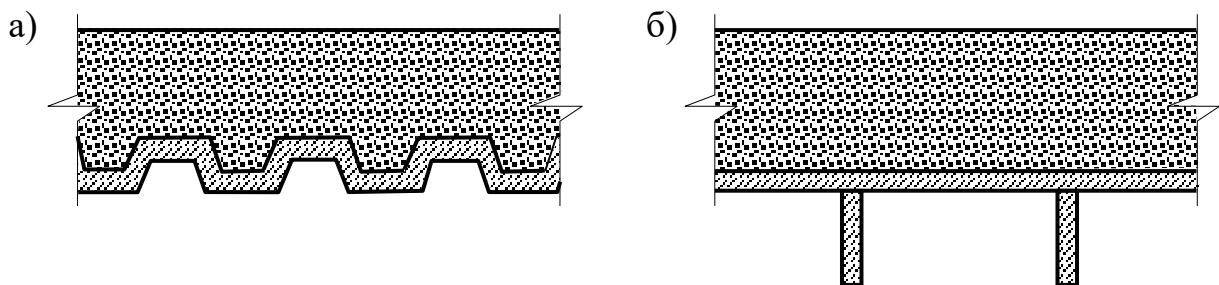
Поперечні перерізи сталезалізобетонних плит:
